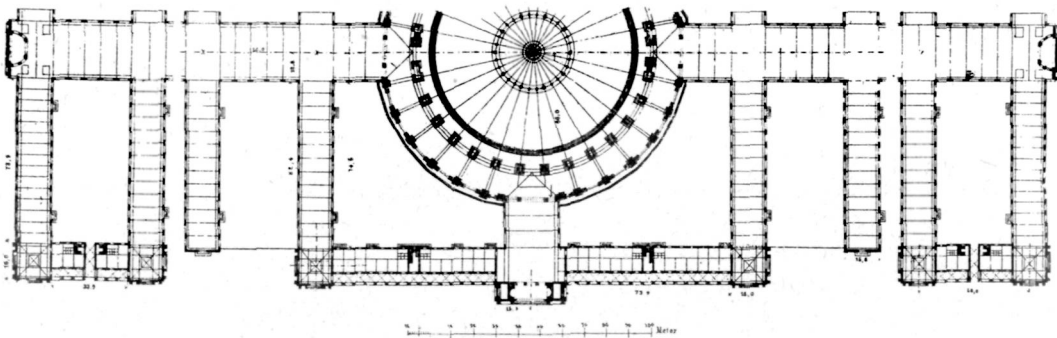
Ausstellungsanlage Wien 1873. Grundriß
